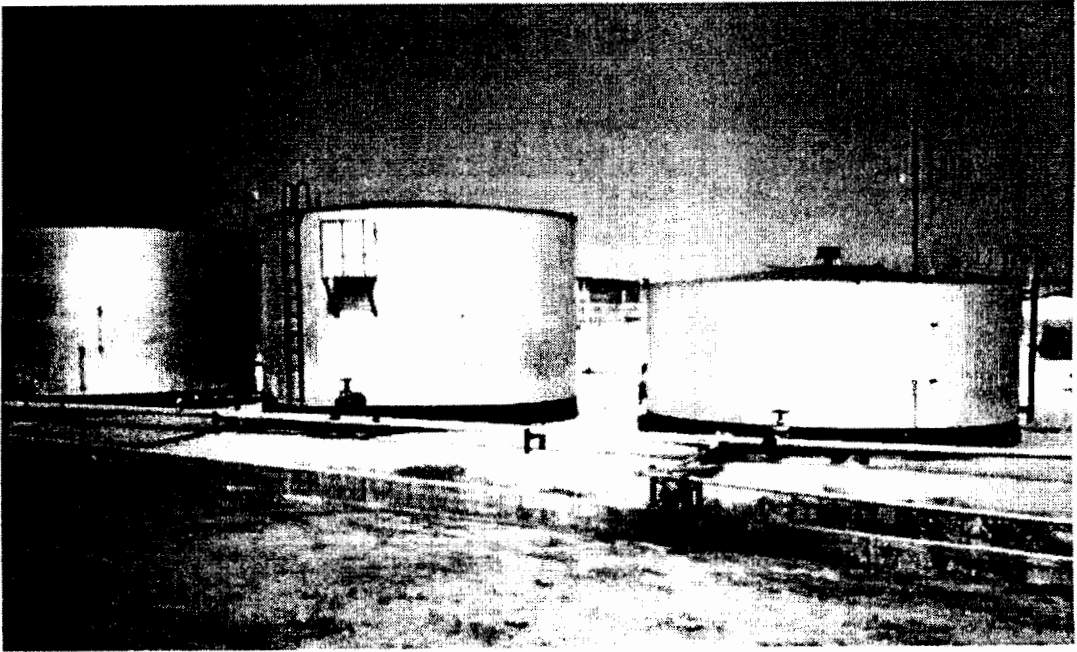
TANQUES DE PLANCHAS SOLDADAS
